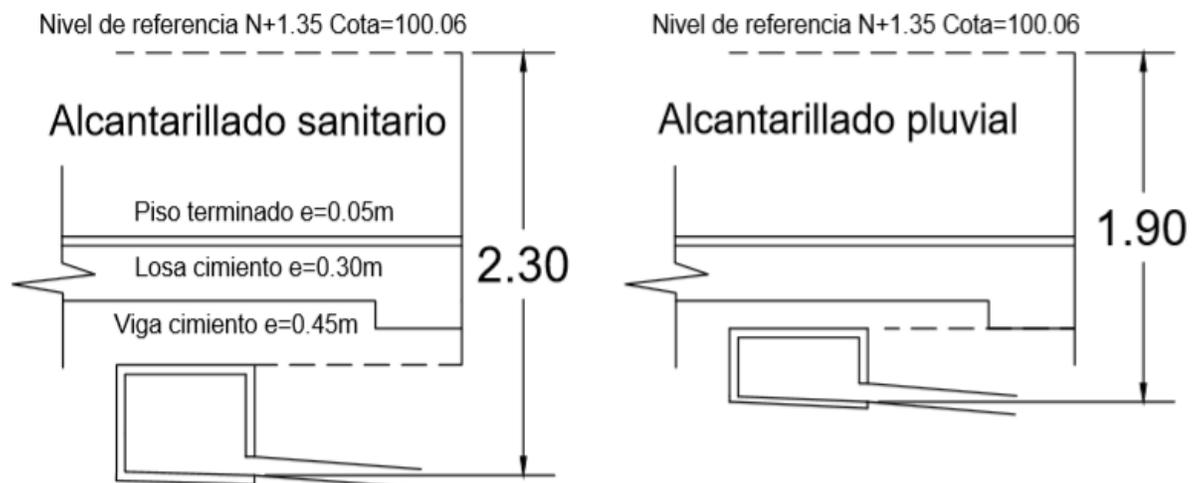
Profundidades de cajas iniciales tanto para alcantarillado pluvial como para alcantarillado sanitario.
